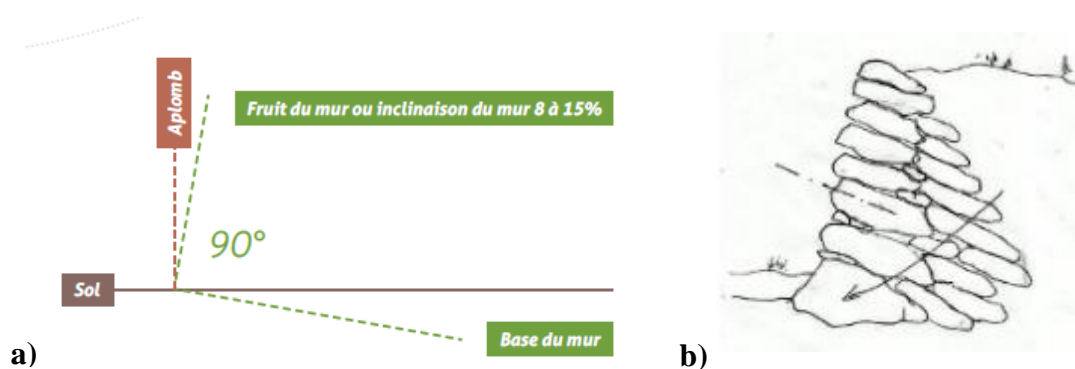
Execução de muro em socalco: a) Inclinação do muro; b) Sentido de colocação das pedras
